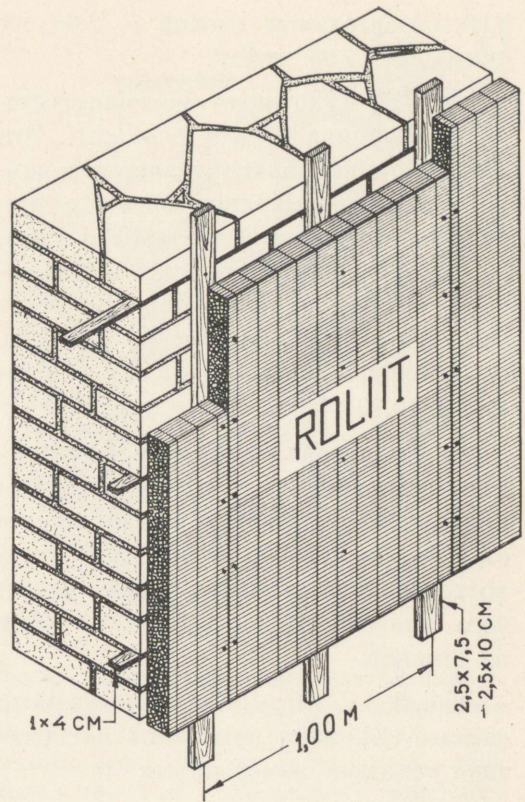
Прикрепление термоизоляционной плиты к каменной стене.
